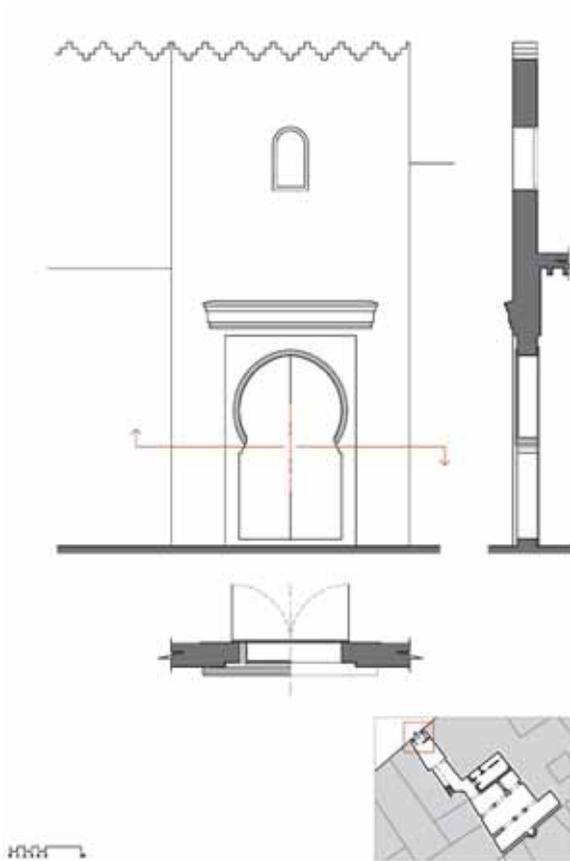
Descripción gráfica de la fachada y puerta exterior.
